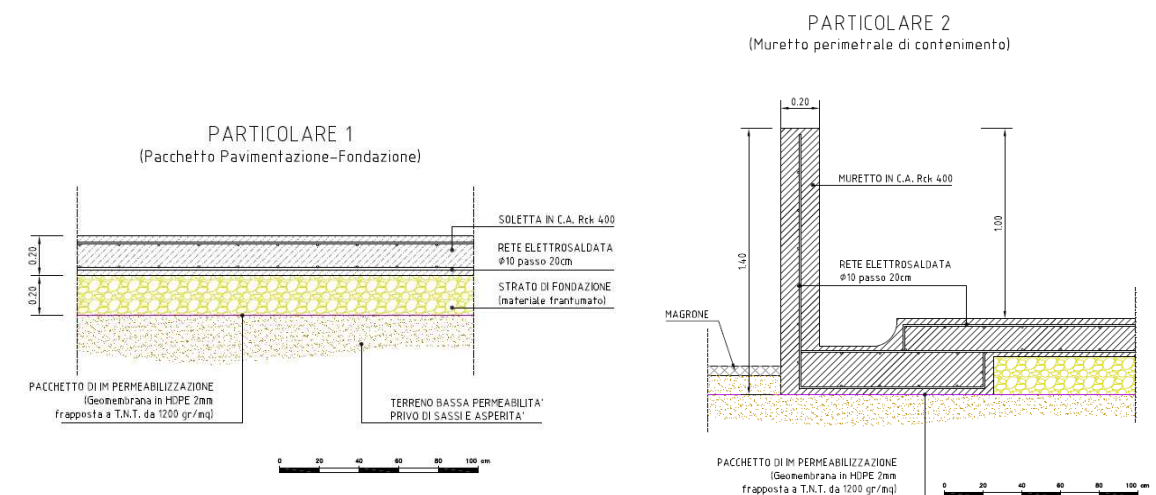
Particolari dei pacchetti di fondazione e del muro perimetrale di contenimento
